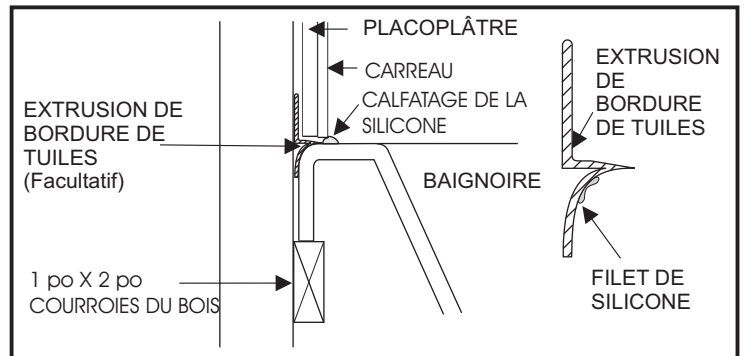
TOMBER -DANS LE BAQUET DANS L'INSTALLATION DE NICHE. LE BOIS SANGLE, EXTRUSIONS DE TUILES ET RECOUVREMENT MURAL.
